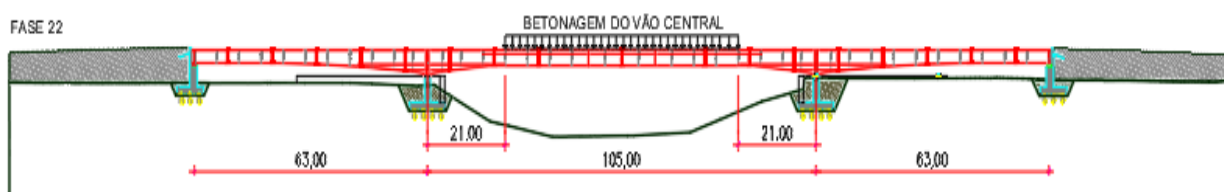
Betonagem do vão central do tabuleiro. Adaptado de [40].
